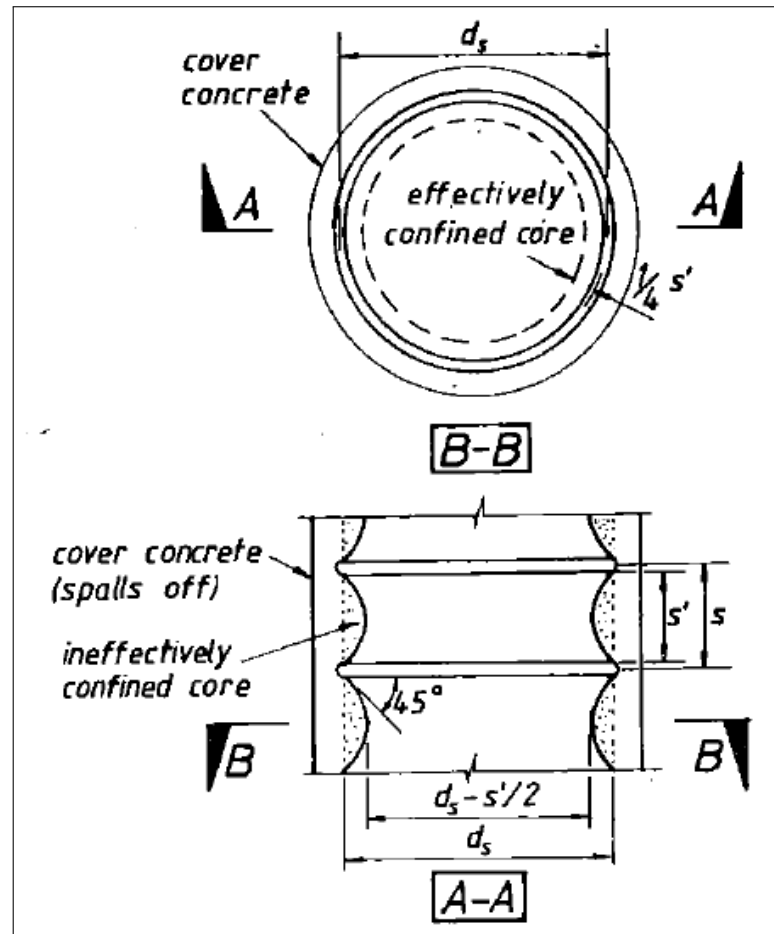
Mecanismo de arco en columnas circulares.<sup>25</sup>
